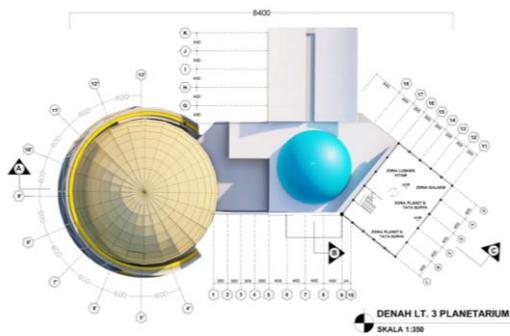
Layout plan (Sumber: Hasil Desain, 2021)
